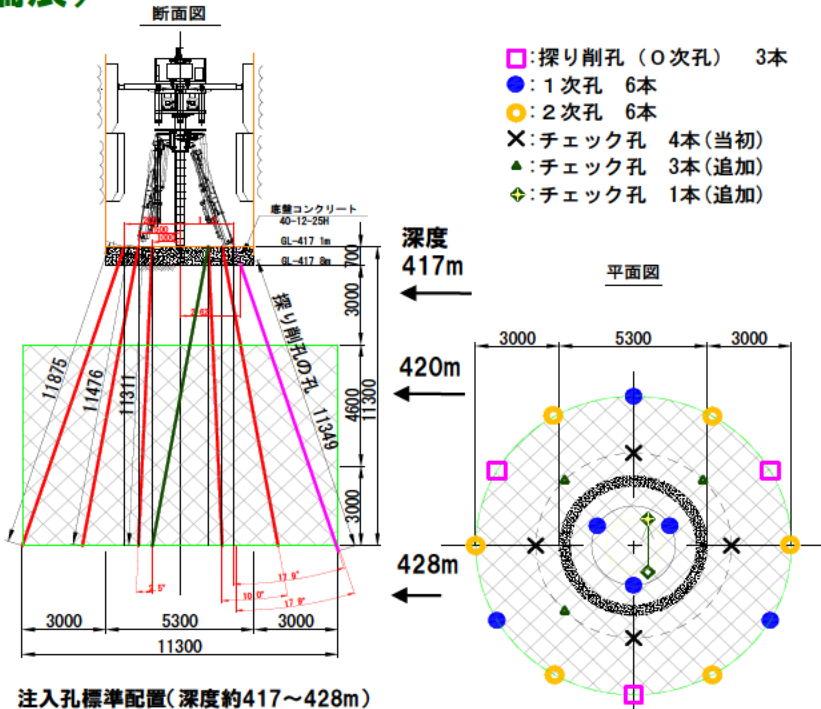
立坑に適用したグラウト孔の配置図(左:断面図, 右:平面図)
